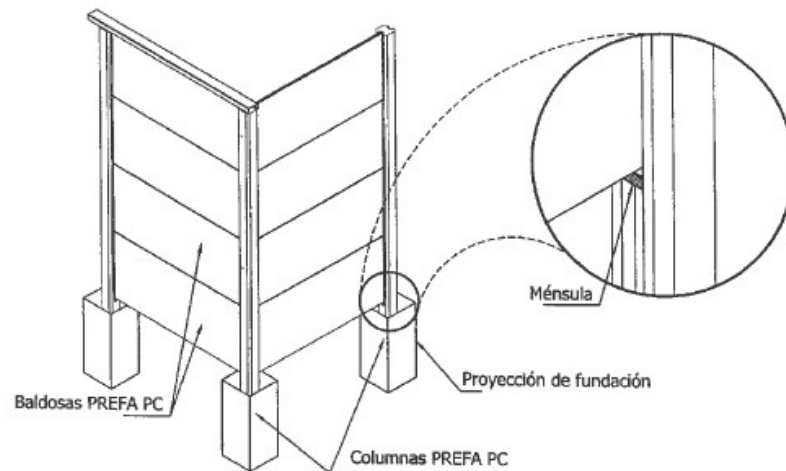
Colocación de baldosas - PrefaCR, 2021.
